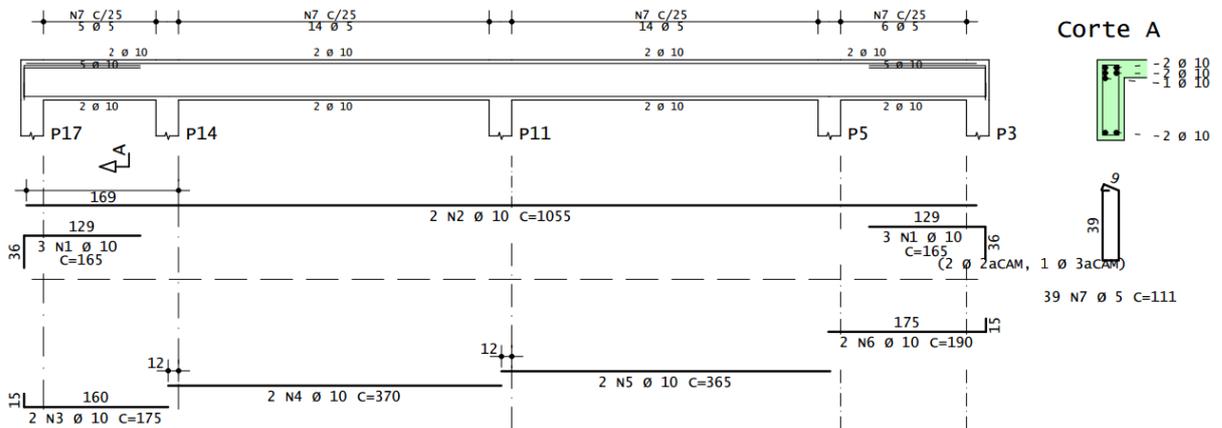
Armadura da viga V10 – coberta (nível +6,00)
